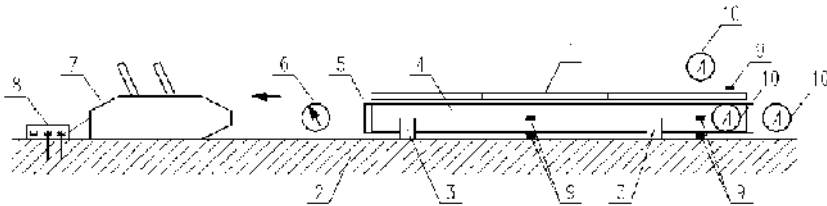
Общий вид схемы испытательного стенда фрагмента фасадной системы.
